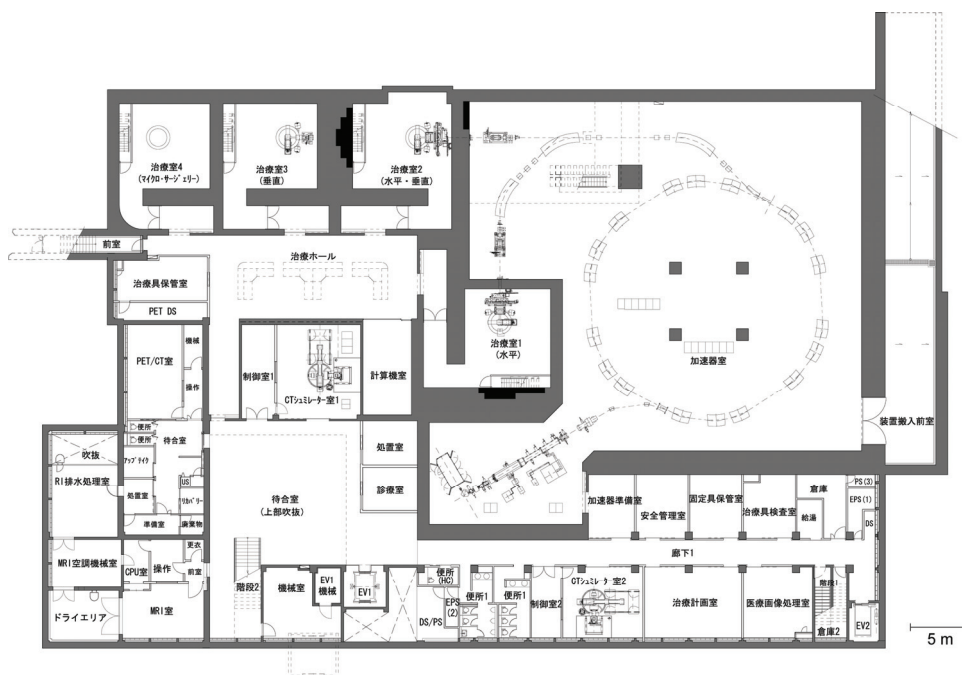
建設中の群馬大学重粒子線照射施設 地下1階平面図
